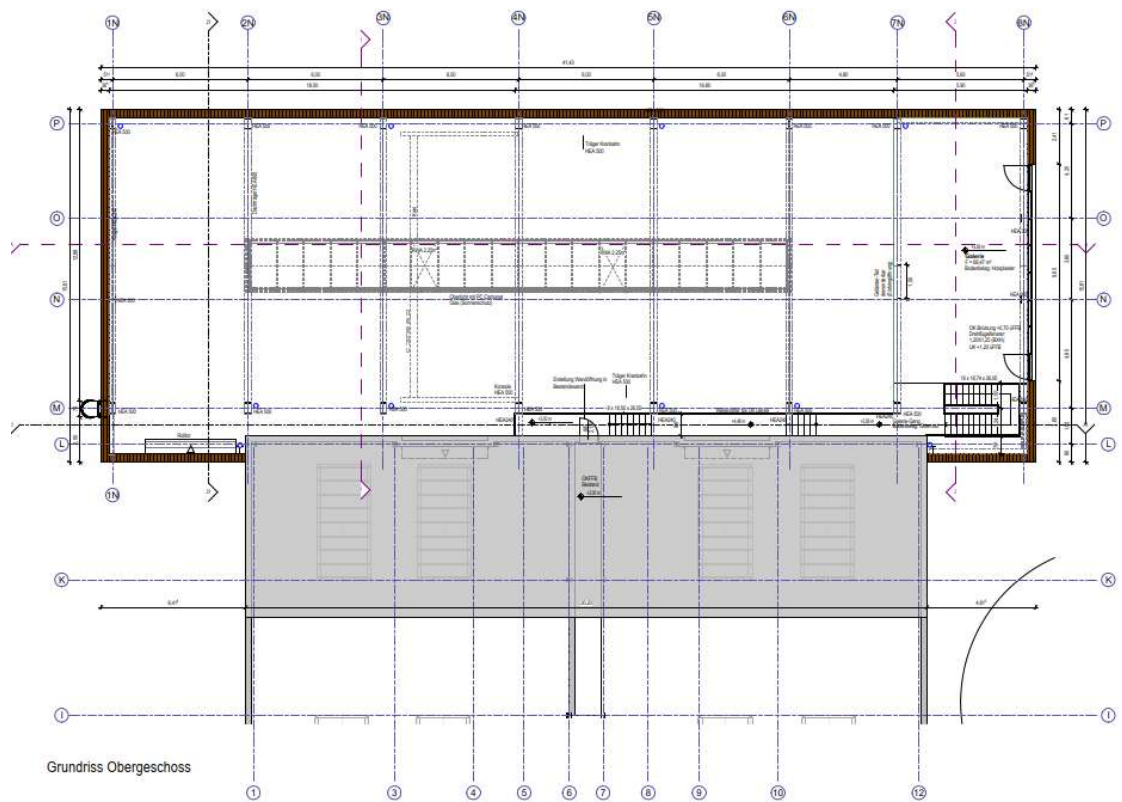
Grundriss Galerie, Quelle: Objektplaner
